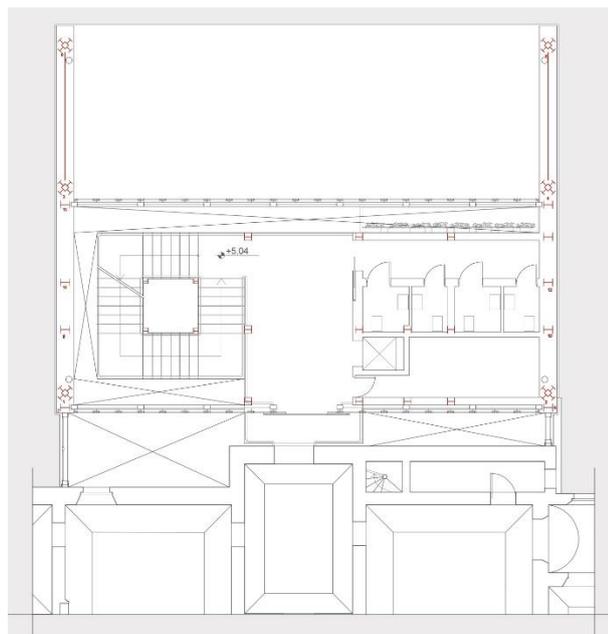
Particolare della pianta strutturale del primo piano. (EdA)
